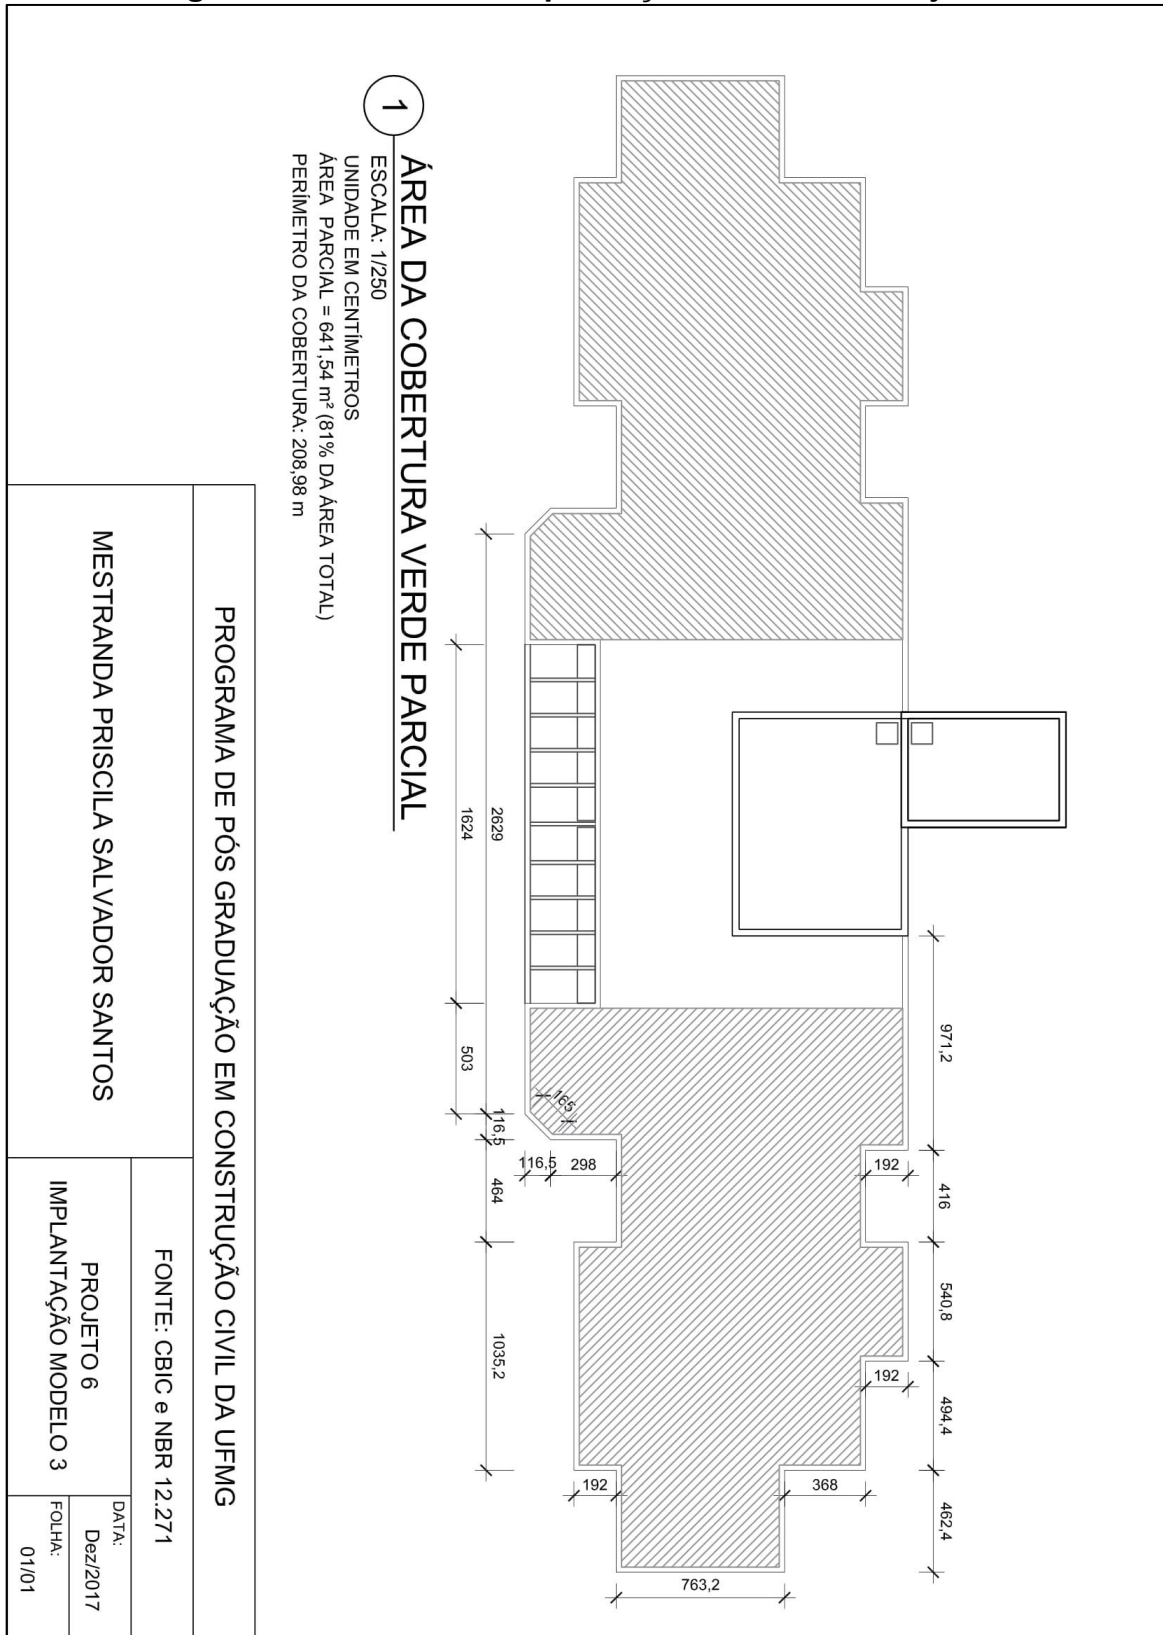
Planta de Implantação Modelo 3 – Projeto 5
